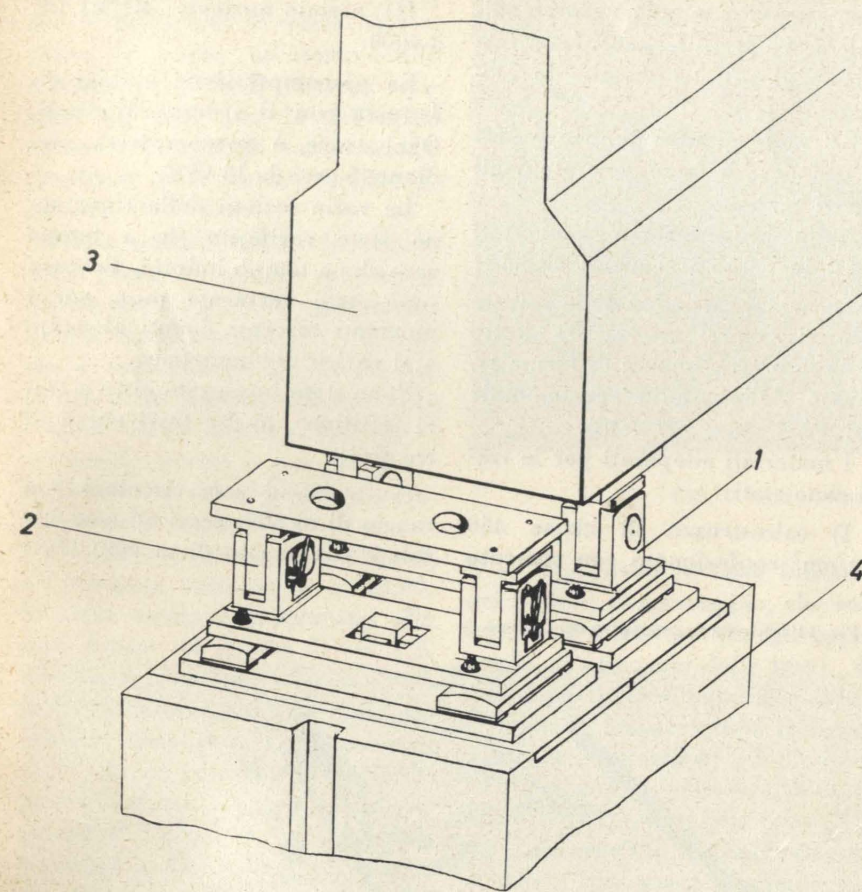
Apparecchi d'appoggio: 1) Piastra fissa; 2) Piastra mobile; 3) Trave; 4) Pilastro.
